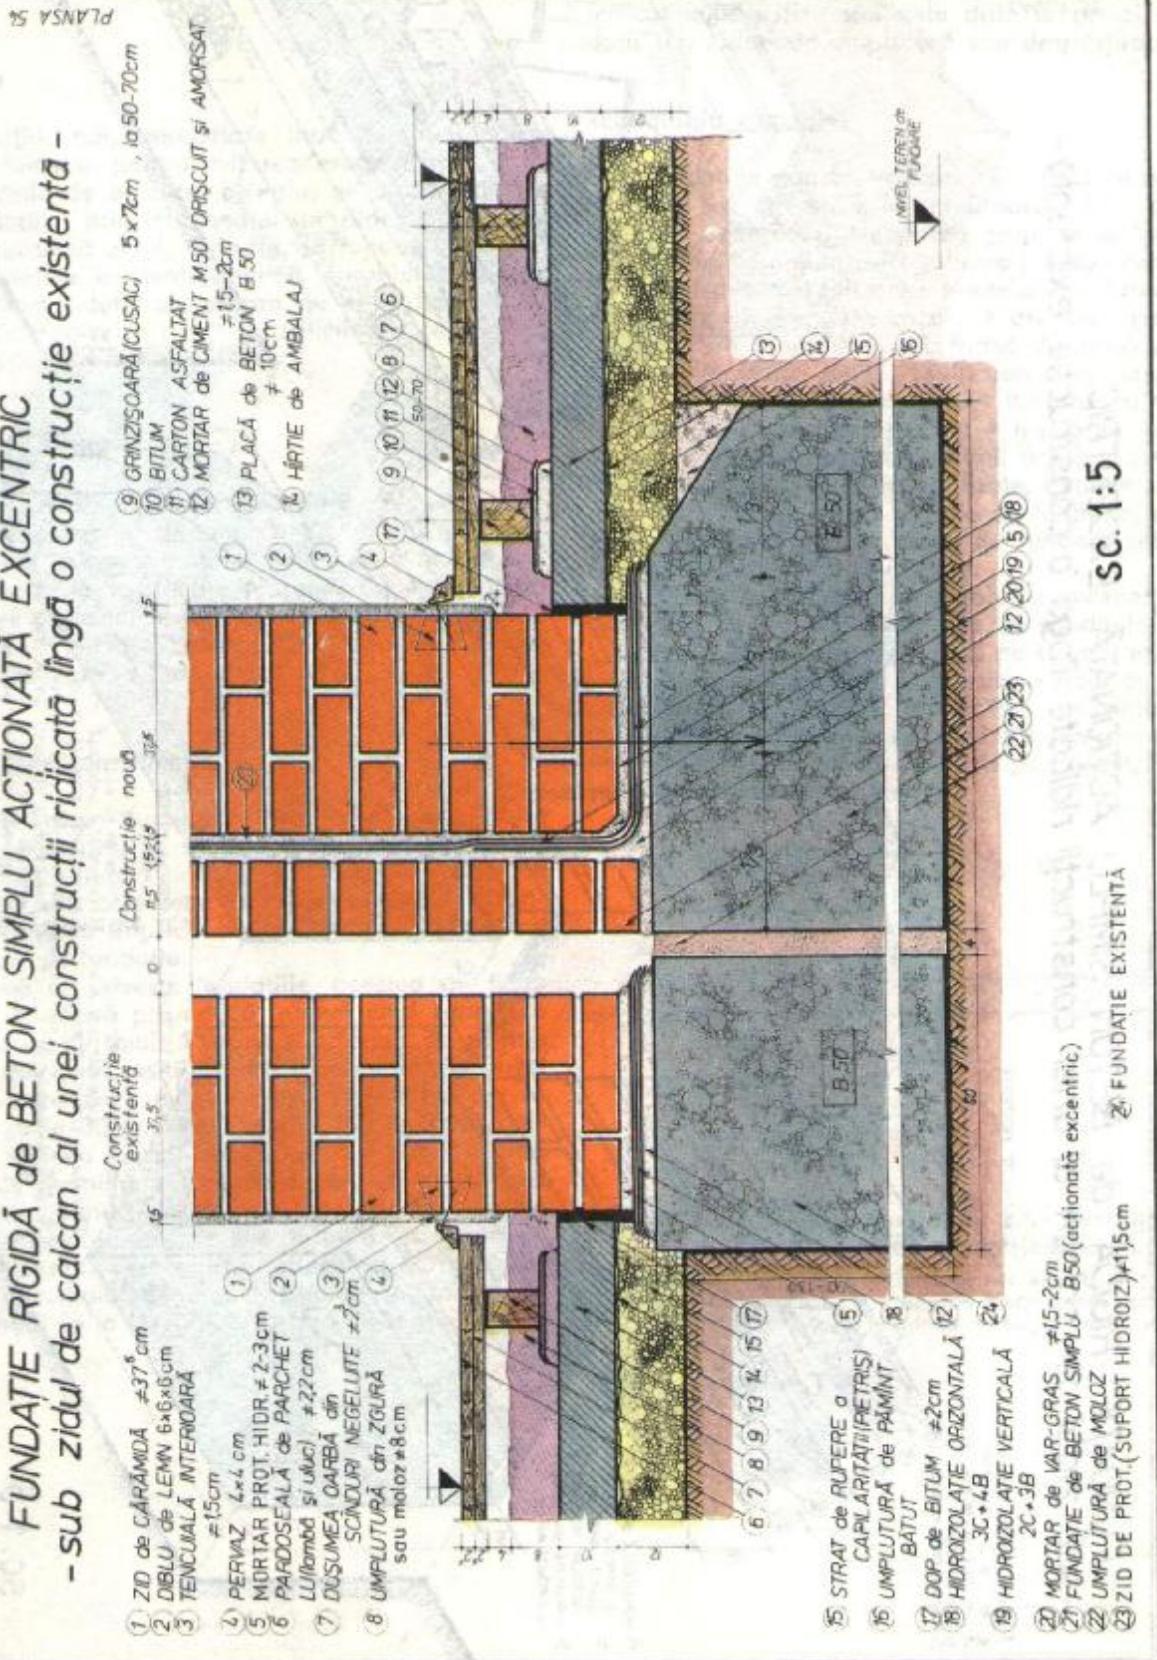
Fundație continuă rigidă, de beton simplu acționată excentric, sub zidul de calcan al unei construcții noi ridicată lângă o construcție existentă. Secțiune transversală.
